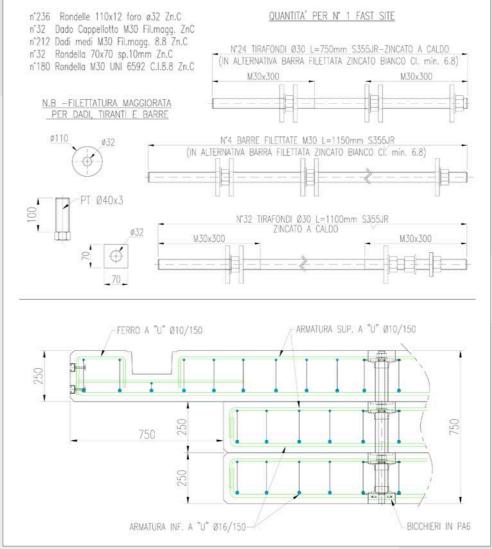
Collegamento moduli FAST SITE® SYSTEM 30
